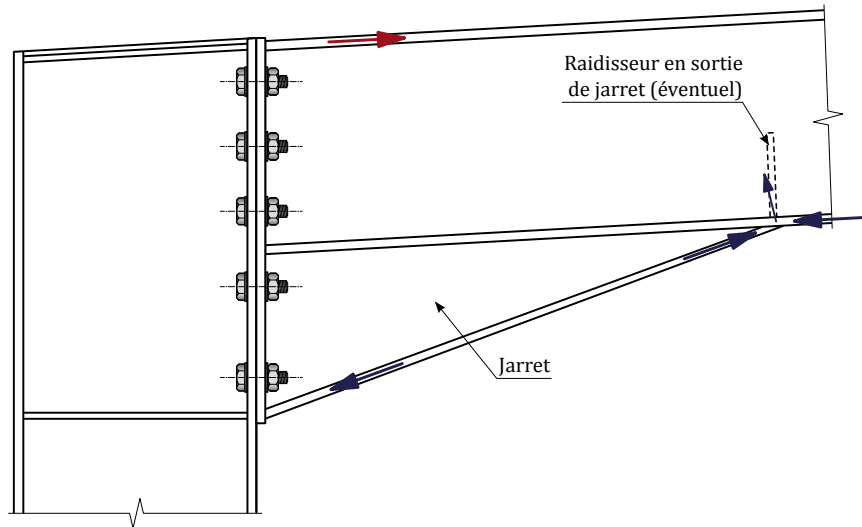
Assemblage poutre-poteau avec renfort de jarret
